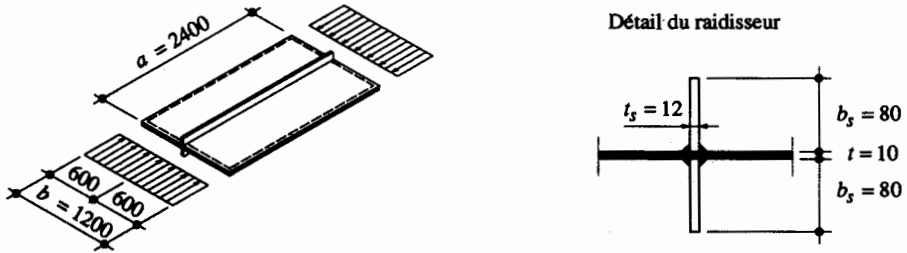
Plaque sollicitée à la compression pure et munie d'un raidisseur.
